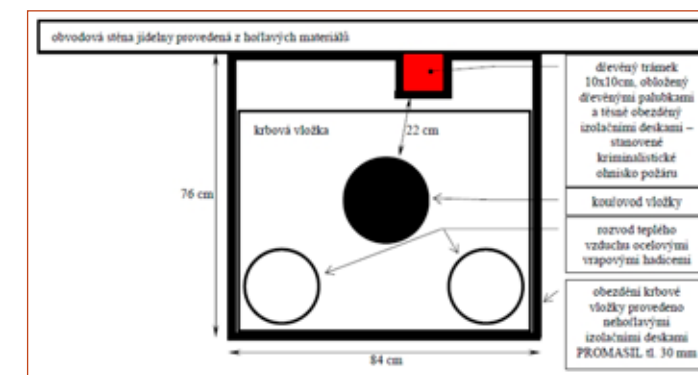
Detailní pohled na obezděnou krbovou vložku – iniciátor požáru.
